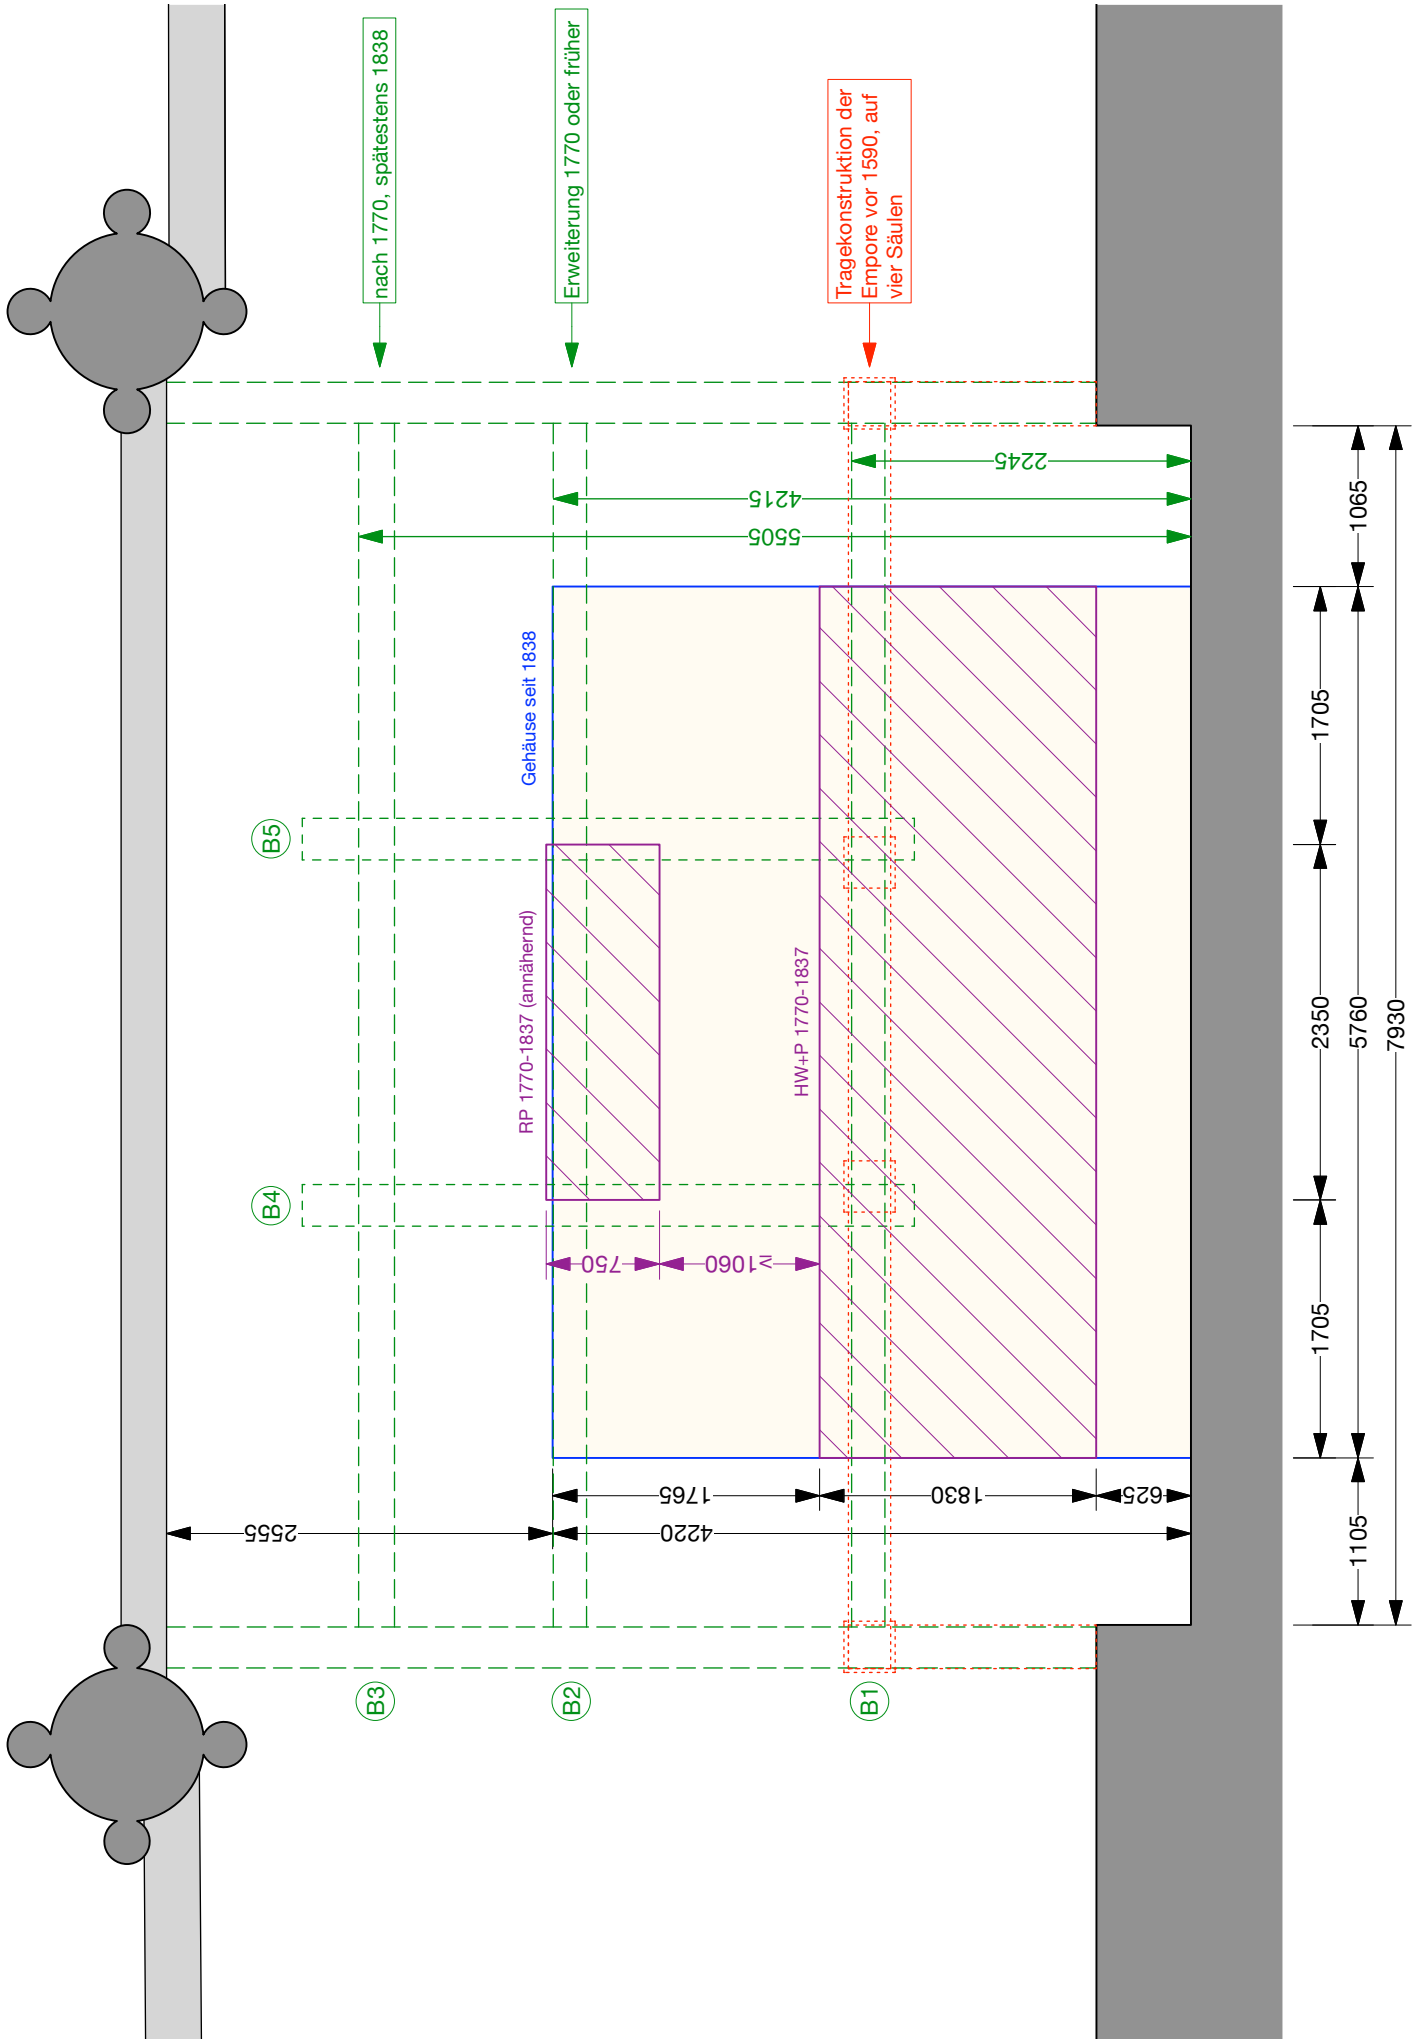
Grundriss Empore (Balkenlage in Längsrichtung unvollständig), Mst. 1:50
